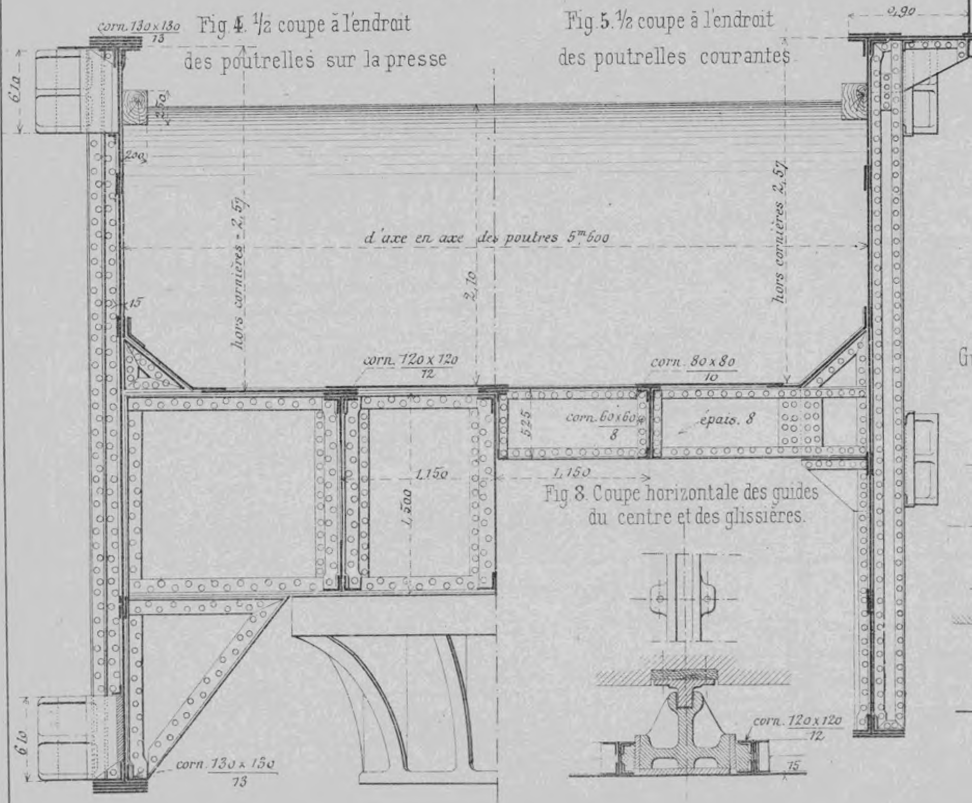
1/2 coupe à l'endroit des poutrelles courantes.
